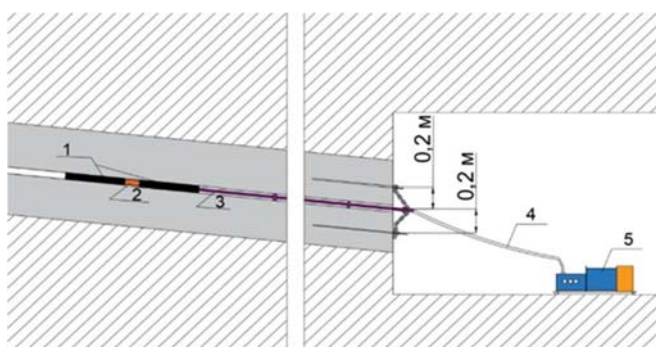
Схема расположения оборудования: 1 — герметизатор; 2 — регулируемый распределитель давления (клапан); 3 — трубки (штанги) высокого давления; 4 — рукав высокого давления; 5 — насосная установка
